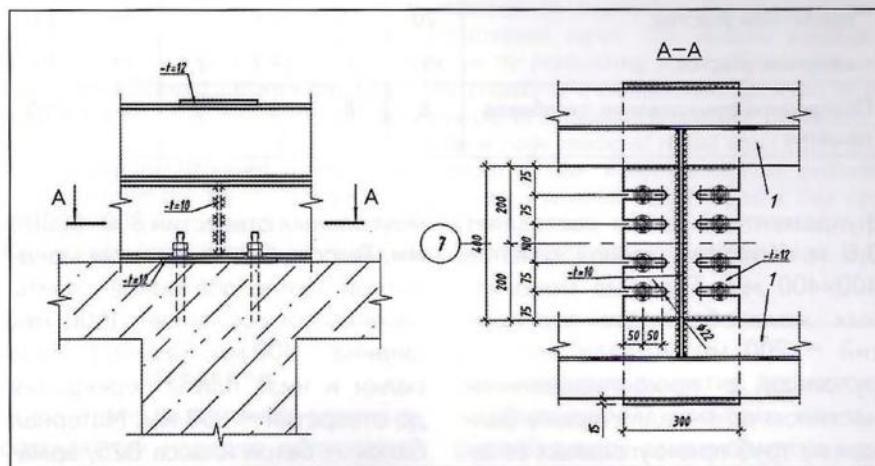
Узел крепления стальной балки к верху железобетонной балки, шаг 1 м (1 – балки 20K2)
